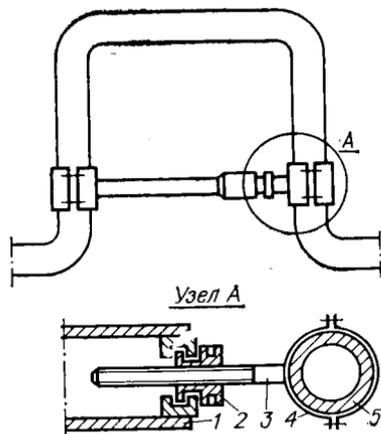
Винтовое приспособление для растяжки компенсаторов:
